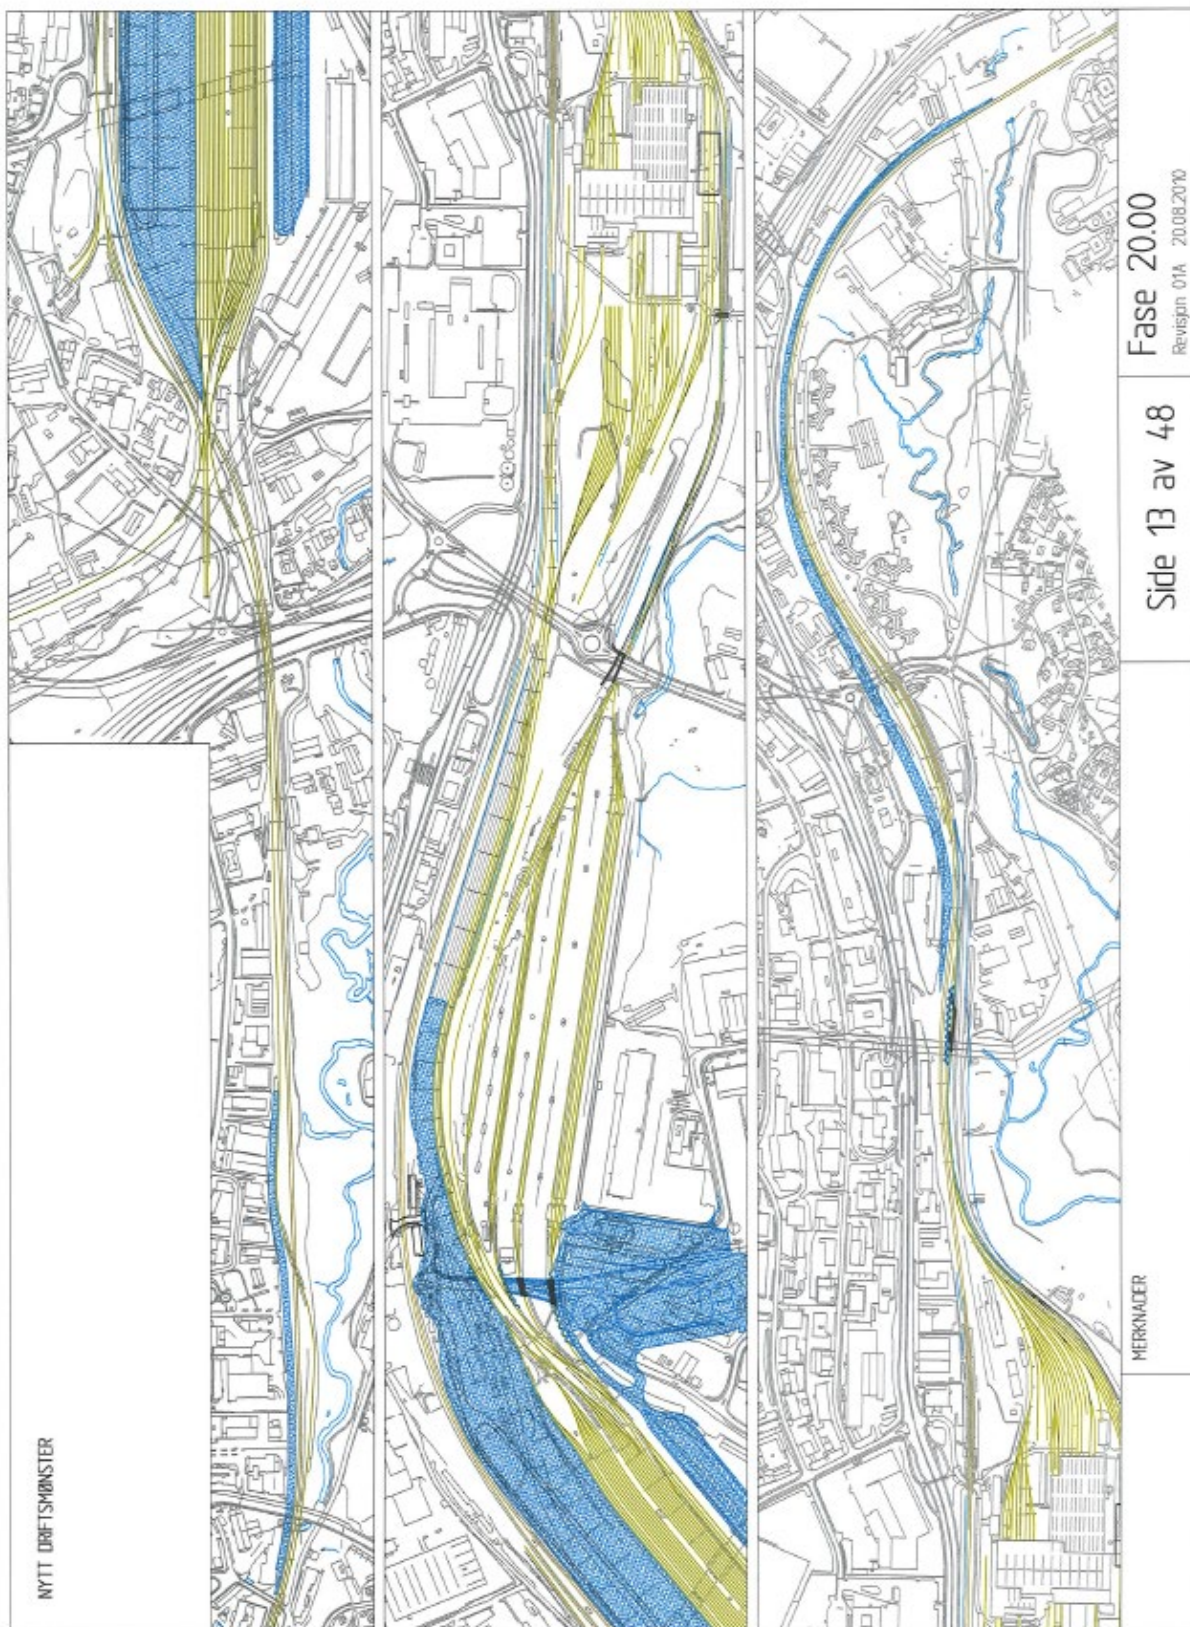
Utbygging, konsept 4.8. Kilde: Hovedplan
